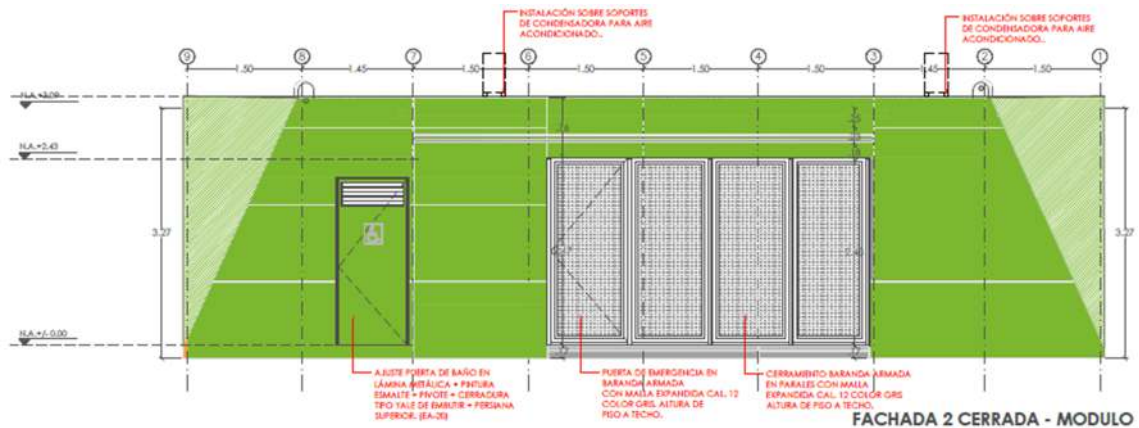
Barandas de malla extendida de piso a techo fachada posterior taquilla. Plano 8. A-201A FACHADA 1-2 cerrada 160819.dwg
